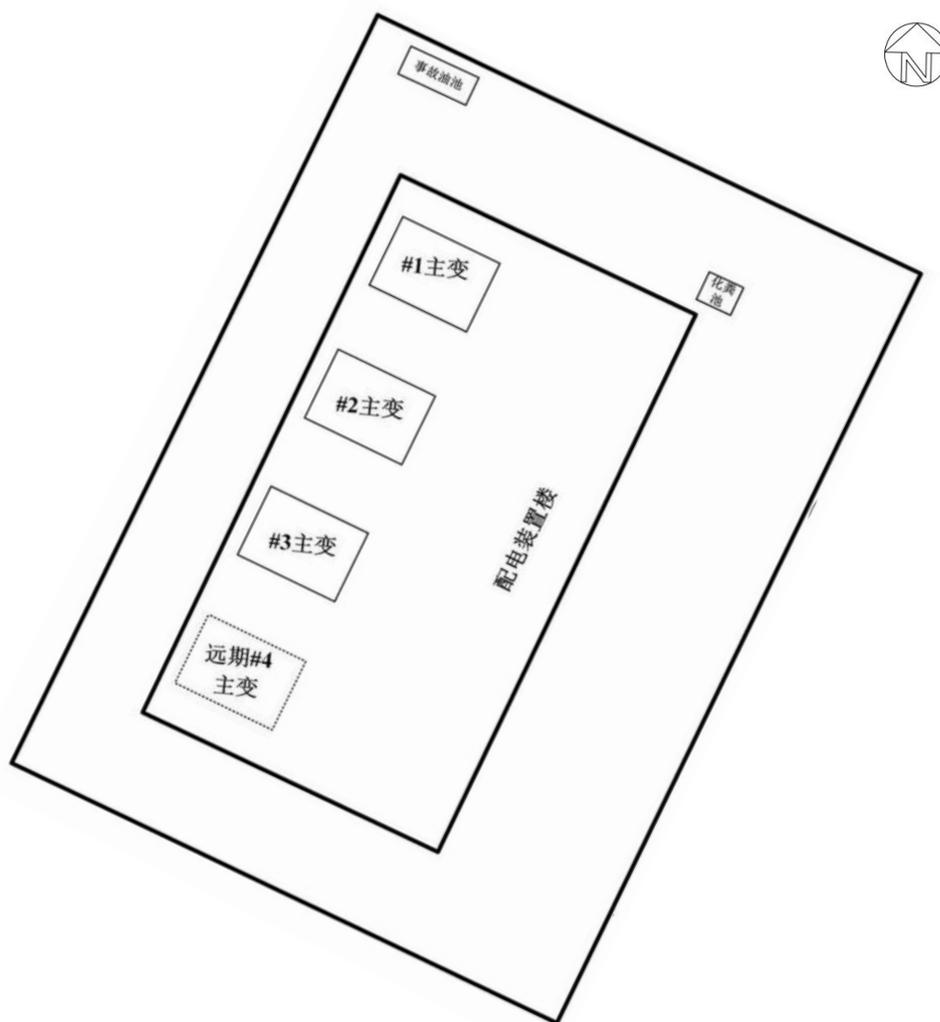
220kV 文旅(长岗) 变电站总平面布置示意图
